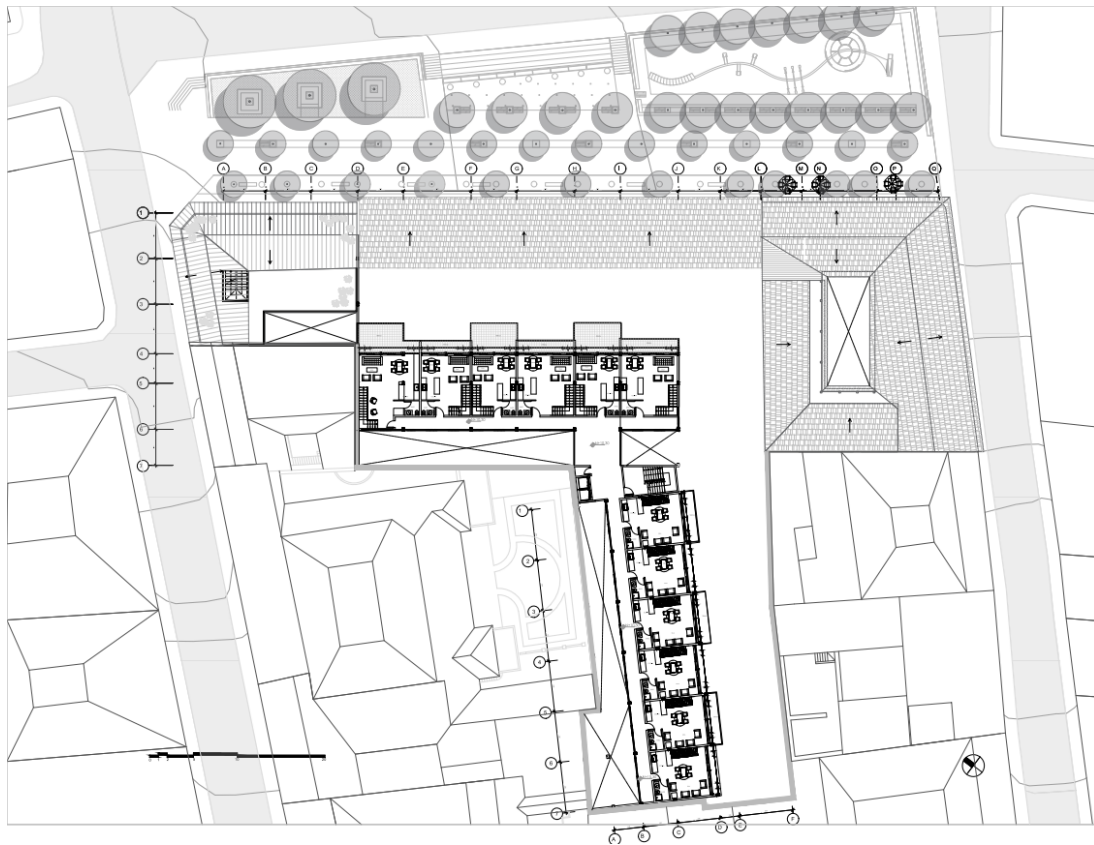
Planta piso 2. Elaborado por Nacevilla 2020
